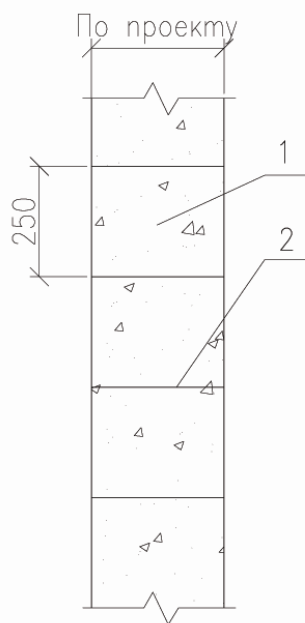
Схема кладки из газобетонных блоков толщиной в один блок:
